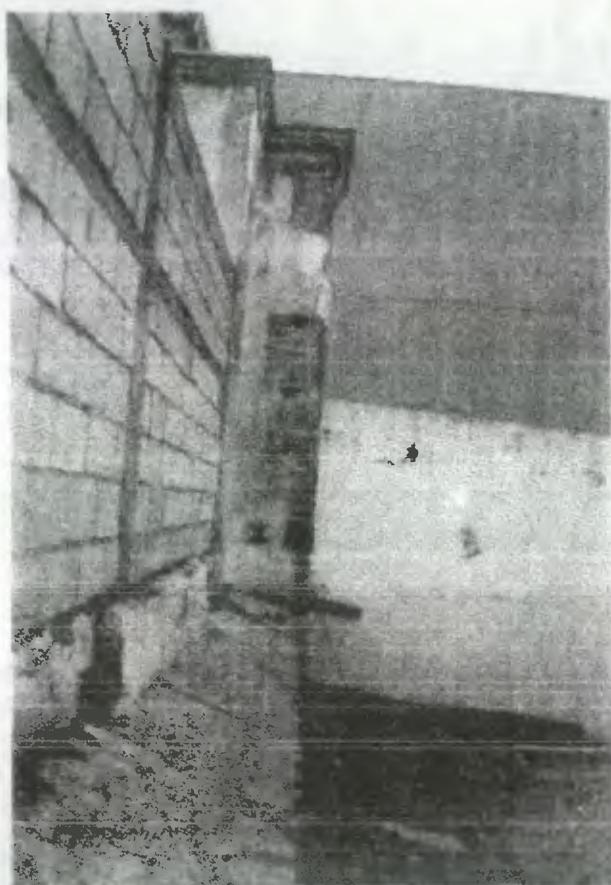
Vista de la parte este del templo donde se puede observar el deterioro que presenta el muro y contrafuerte así también se puede apreciar una gárgoia de piedra que se encuentra en el contrafuerte y el muro de block que fue construido sobre el muro antiguo del templo.
